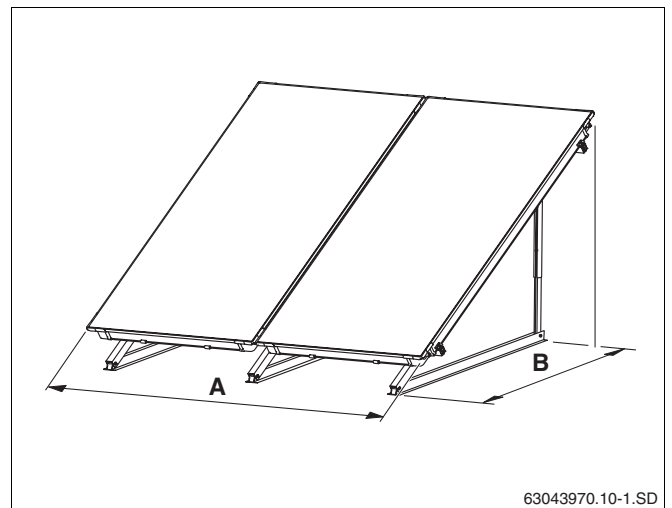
Platzbedarf Kollektorfeld - senkrechte Ausführung
